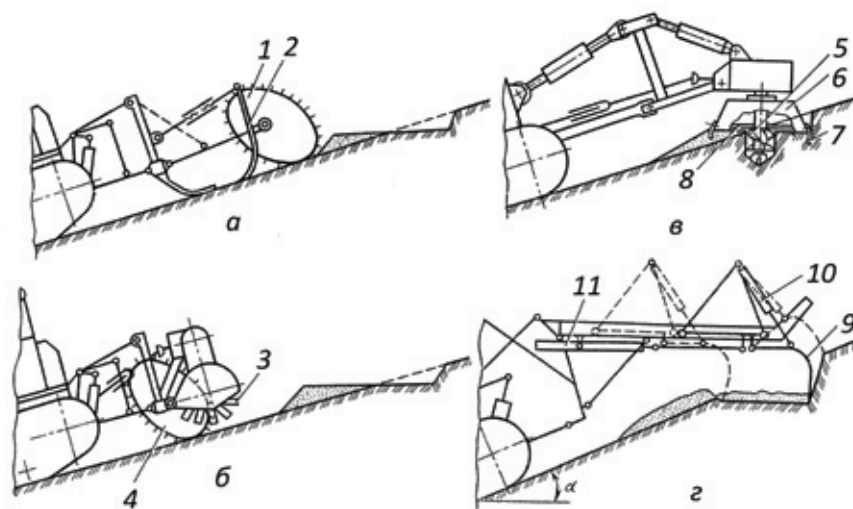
Кинематические схемы привода рабочих органов площадкоделателей: а — с пассивным приводом; б, в — с активным механическим приводом; г — с активным гидравлическим приводом; 1, 4 — опорно-копирующие колеса; 2 — отвал; 3 — фрезерный барабан; 5 — лункообразующее устройство; 6 — кожух; 7 — боковые вертикальные ножи; 8 — радиальные ножи; 9 — рыхлительные зубья; 10 — гидроцилиндр поворота зубьев; 11 — гидроцилиндр перемещения зубьев
